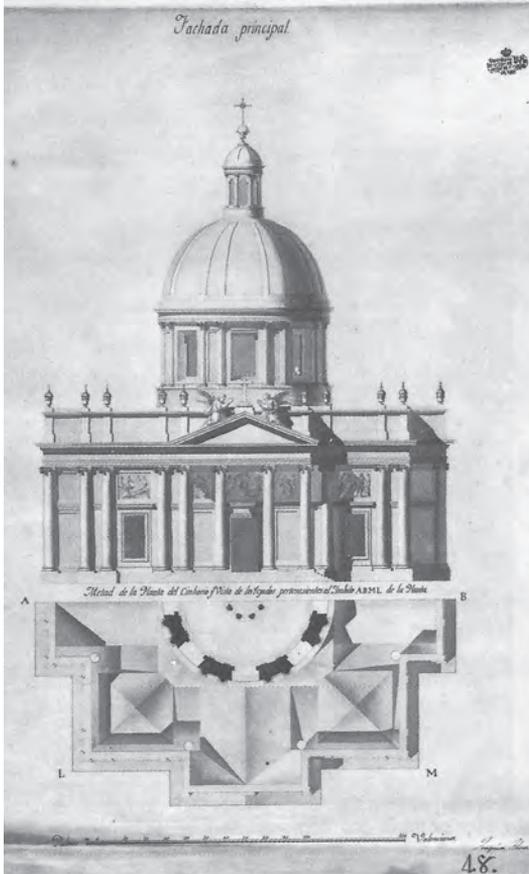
Proyecto de “Capilla Hermita de nueva planta dedicada a Maria Santisima bajo el título de la Purisima Concepcion en las cercanias de una ciudad”, de Joaquín Tomás y Sanz. 1795. Fachada principal. (Bérchez 1981, 140).
